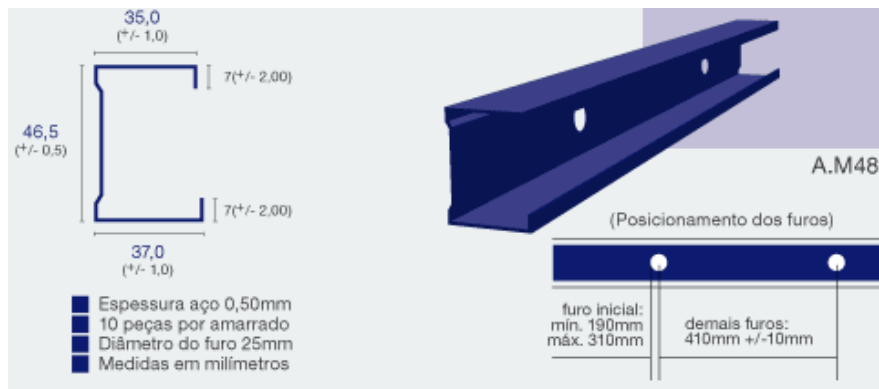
Exemplo de um tipo de perfil dobrado, *Montante 48*, componente do sistema construtivo *dry wall*.
